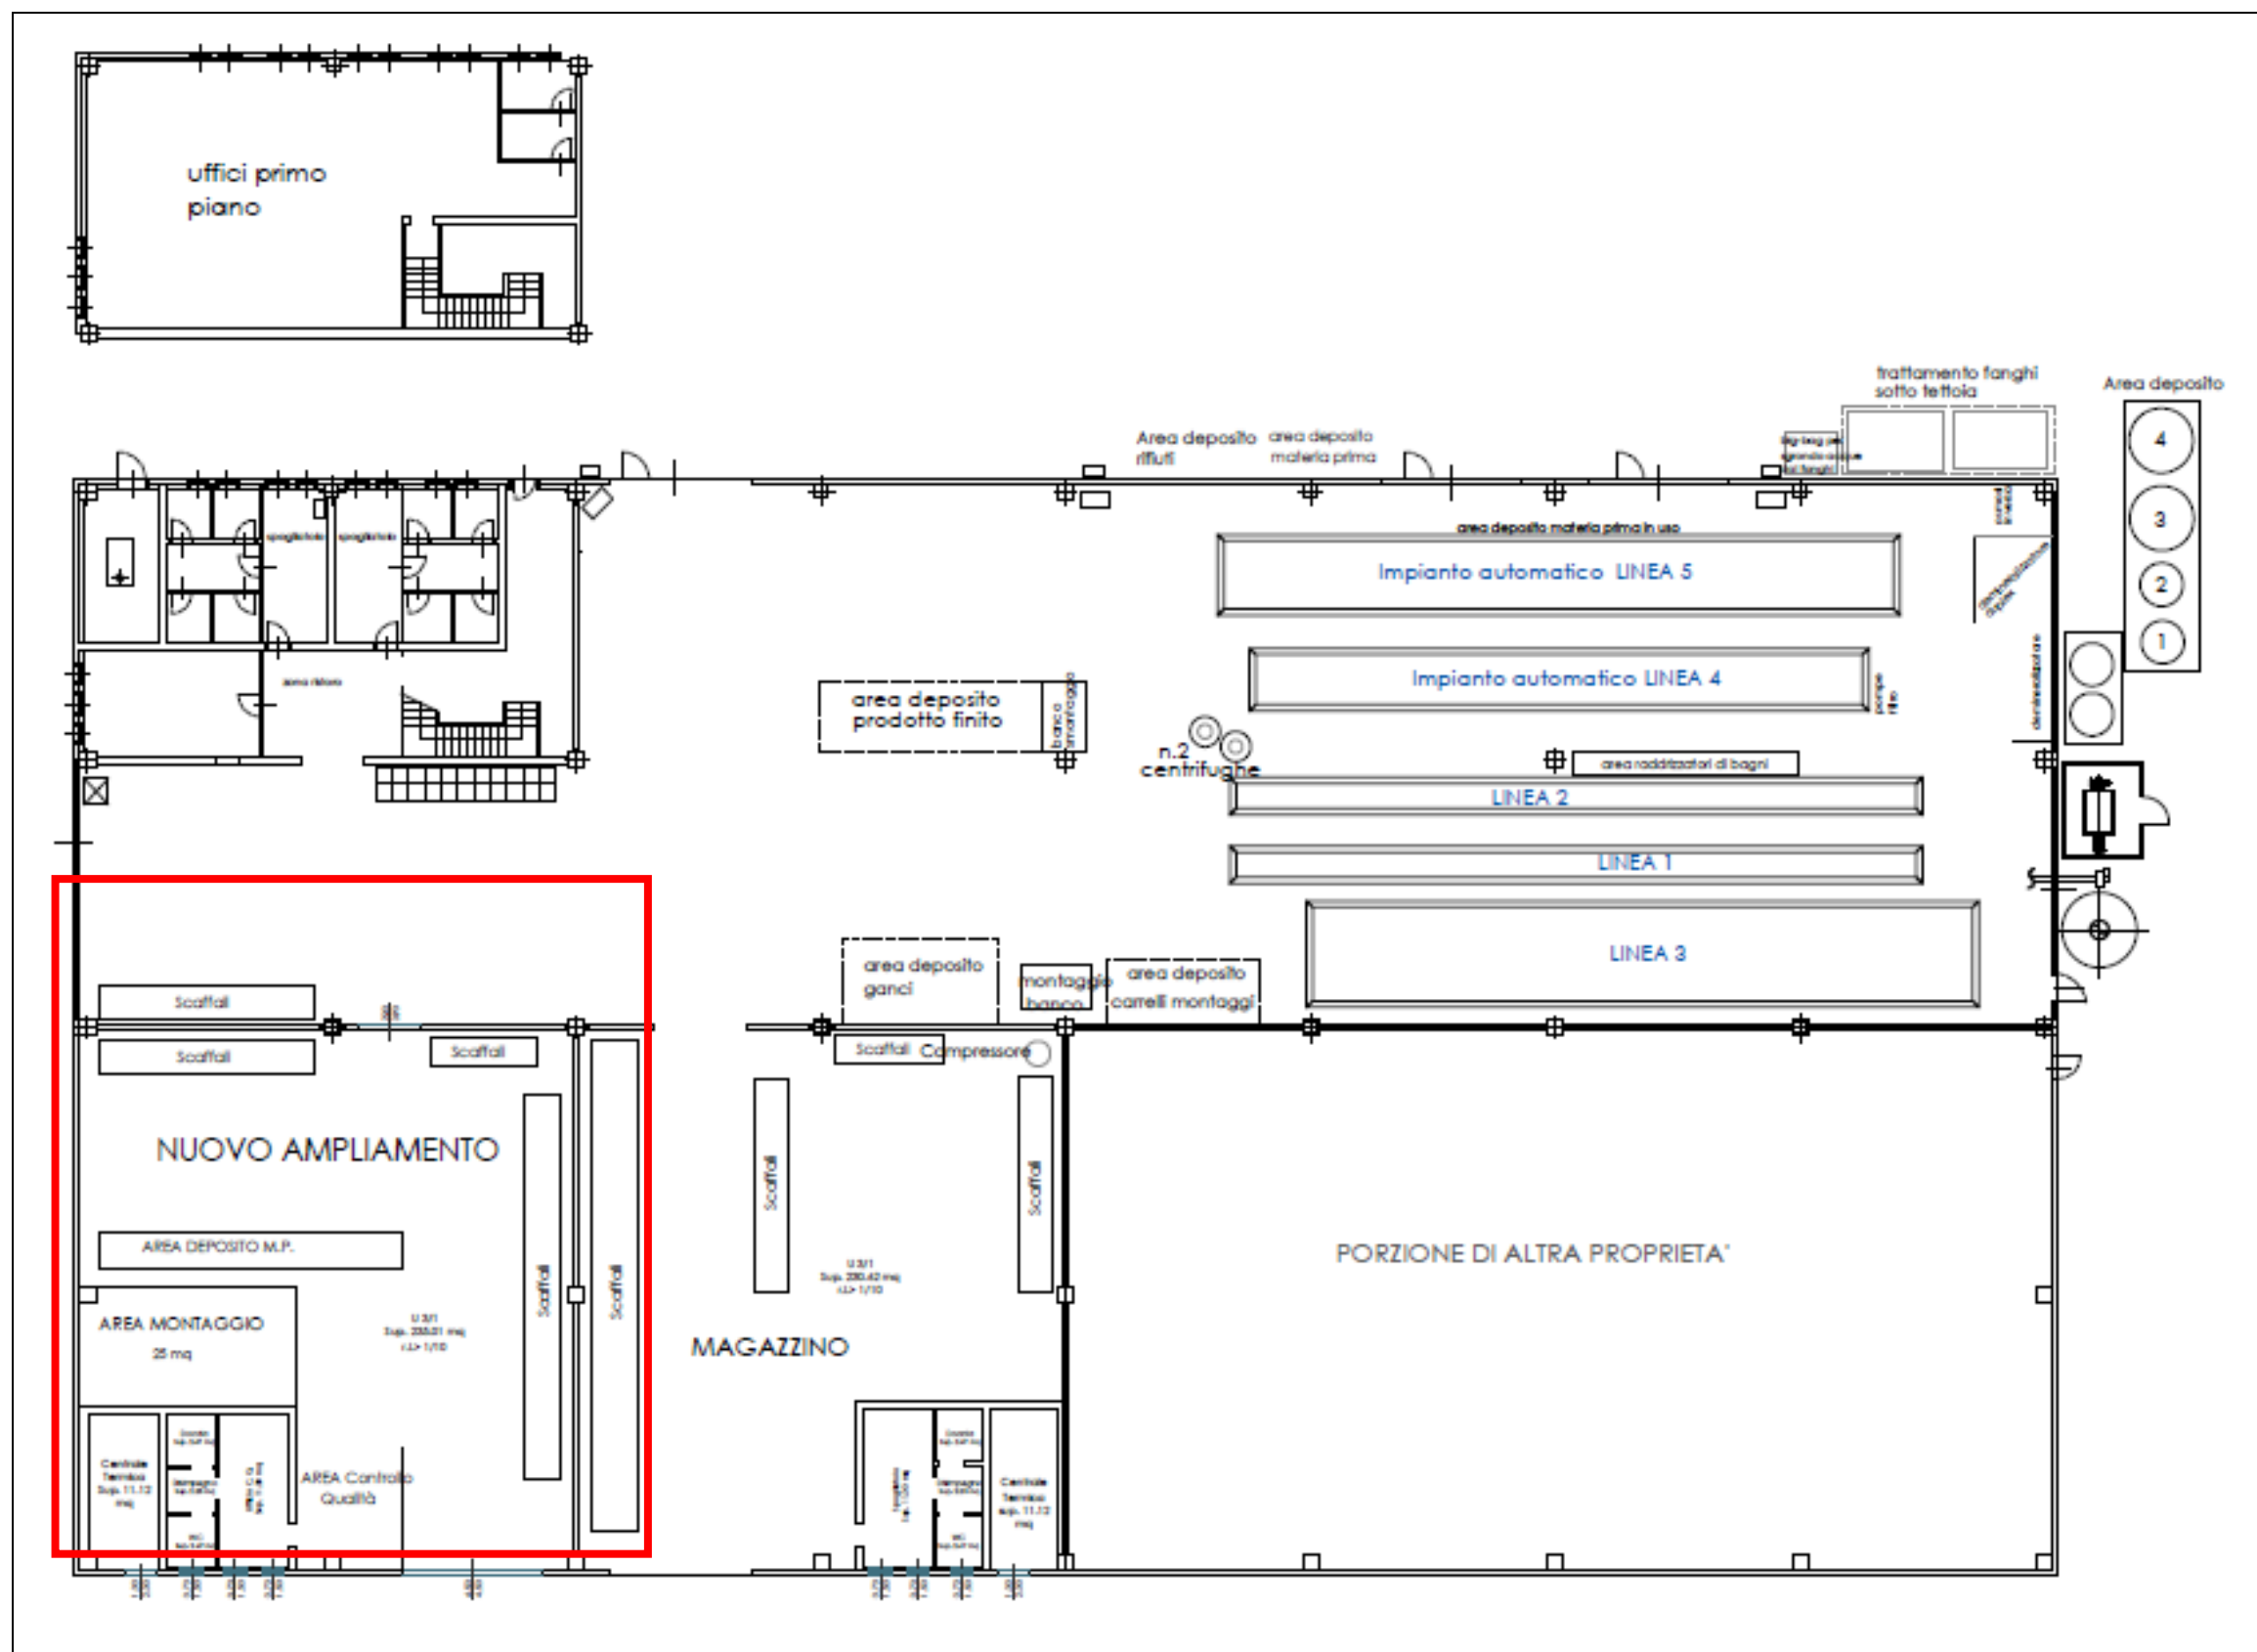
Estratto Allegato Planimetria dell'impianto; il rettangolo rosso individua il locale del nuovo ampliamento.
